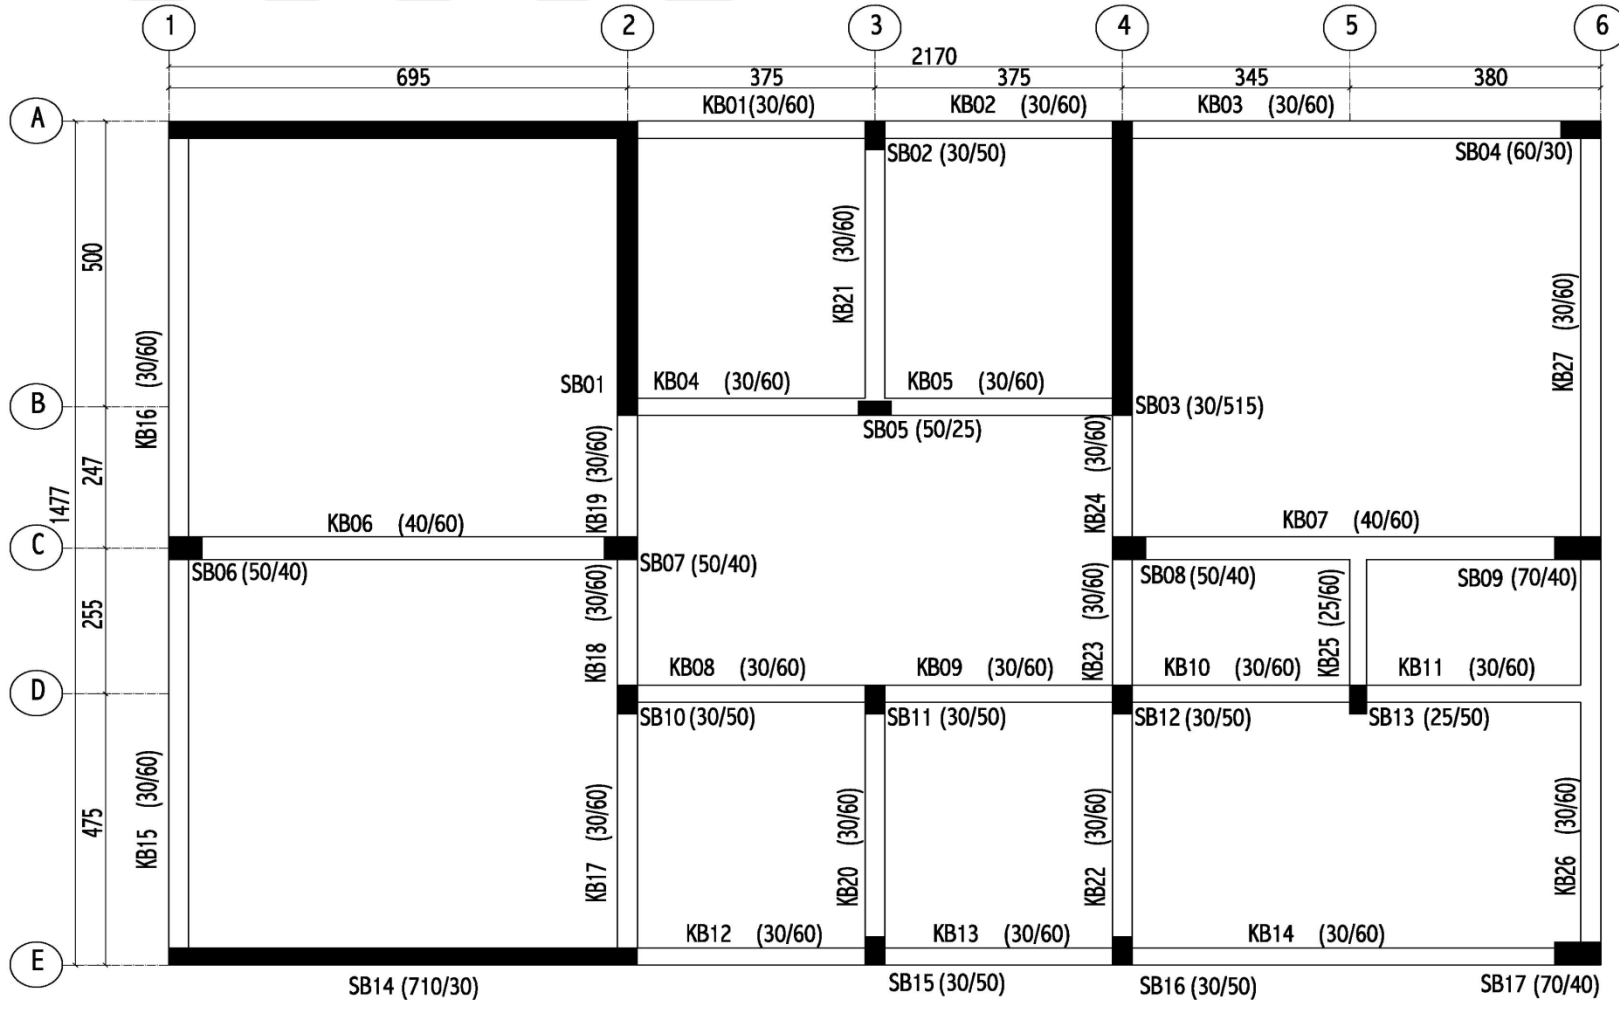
Zübeyde Hanım İlköğretim Okulu - B Blok kalıp planı
